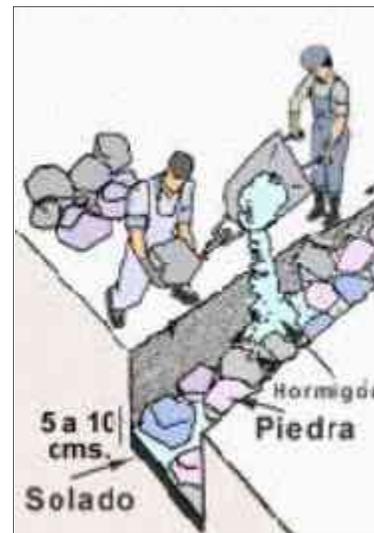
Colocación de piedra. Fuente: Tripod cimentación, <http://annlinet.tripod.com/CIMENTACION.htm>, 28/03/2014.
